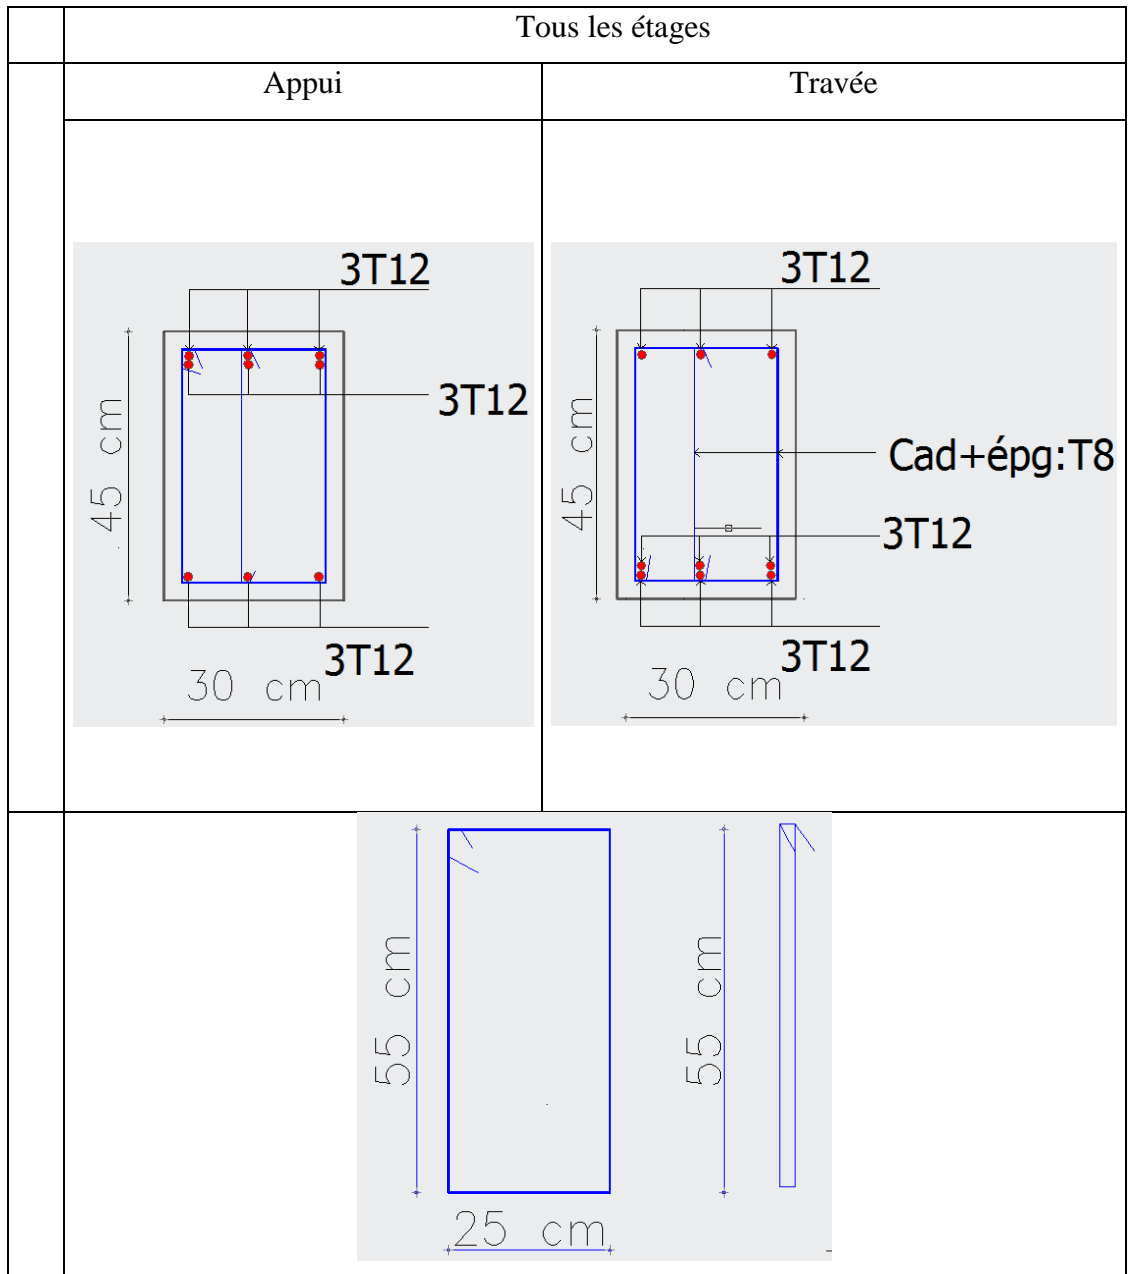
Coupe longitudinale du ferrailage de la poutre principale.
